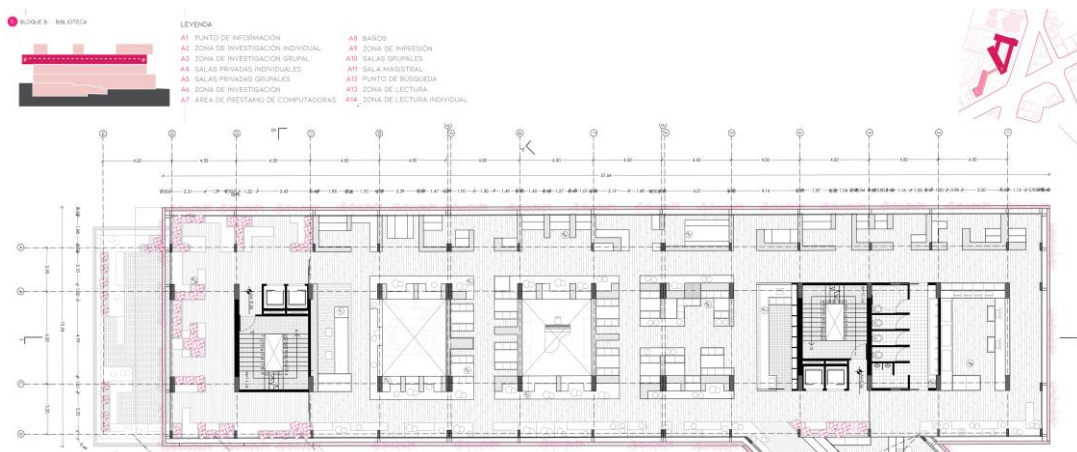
Planta III – Bloque B1. Fuente: (Andrade, 2019).
